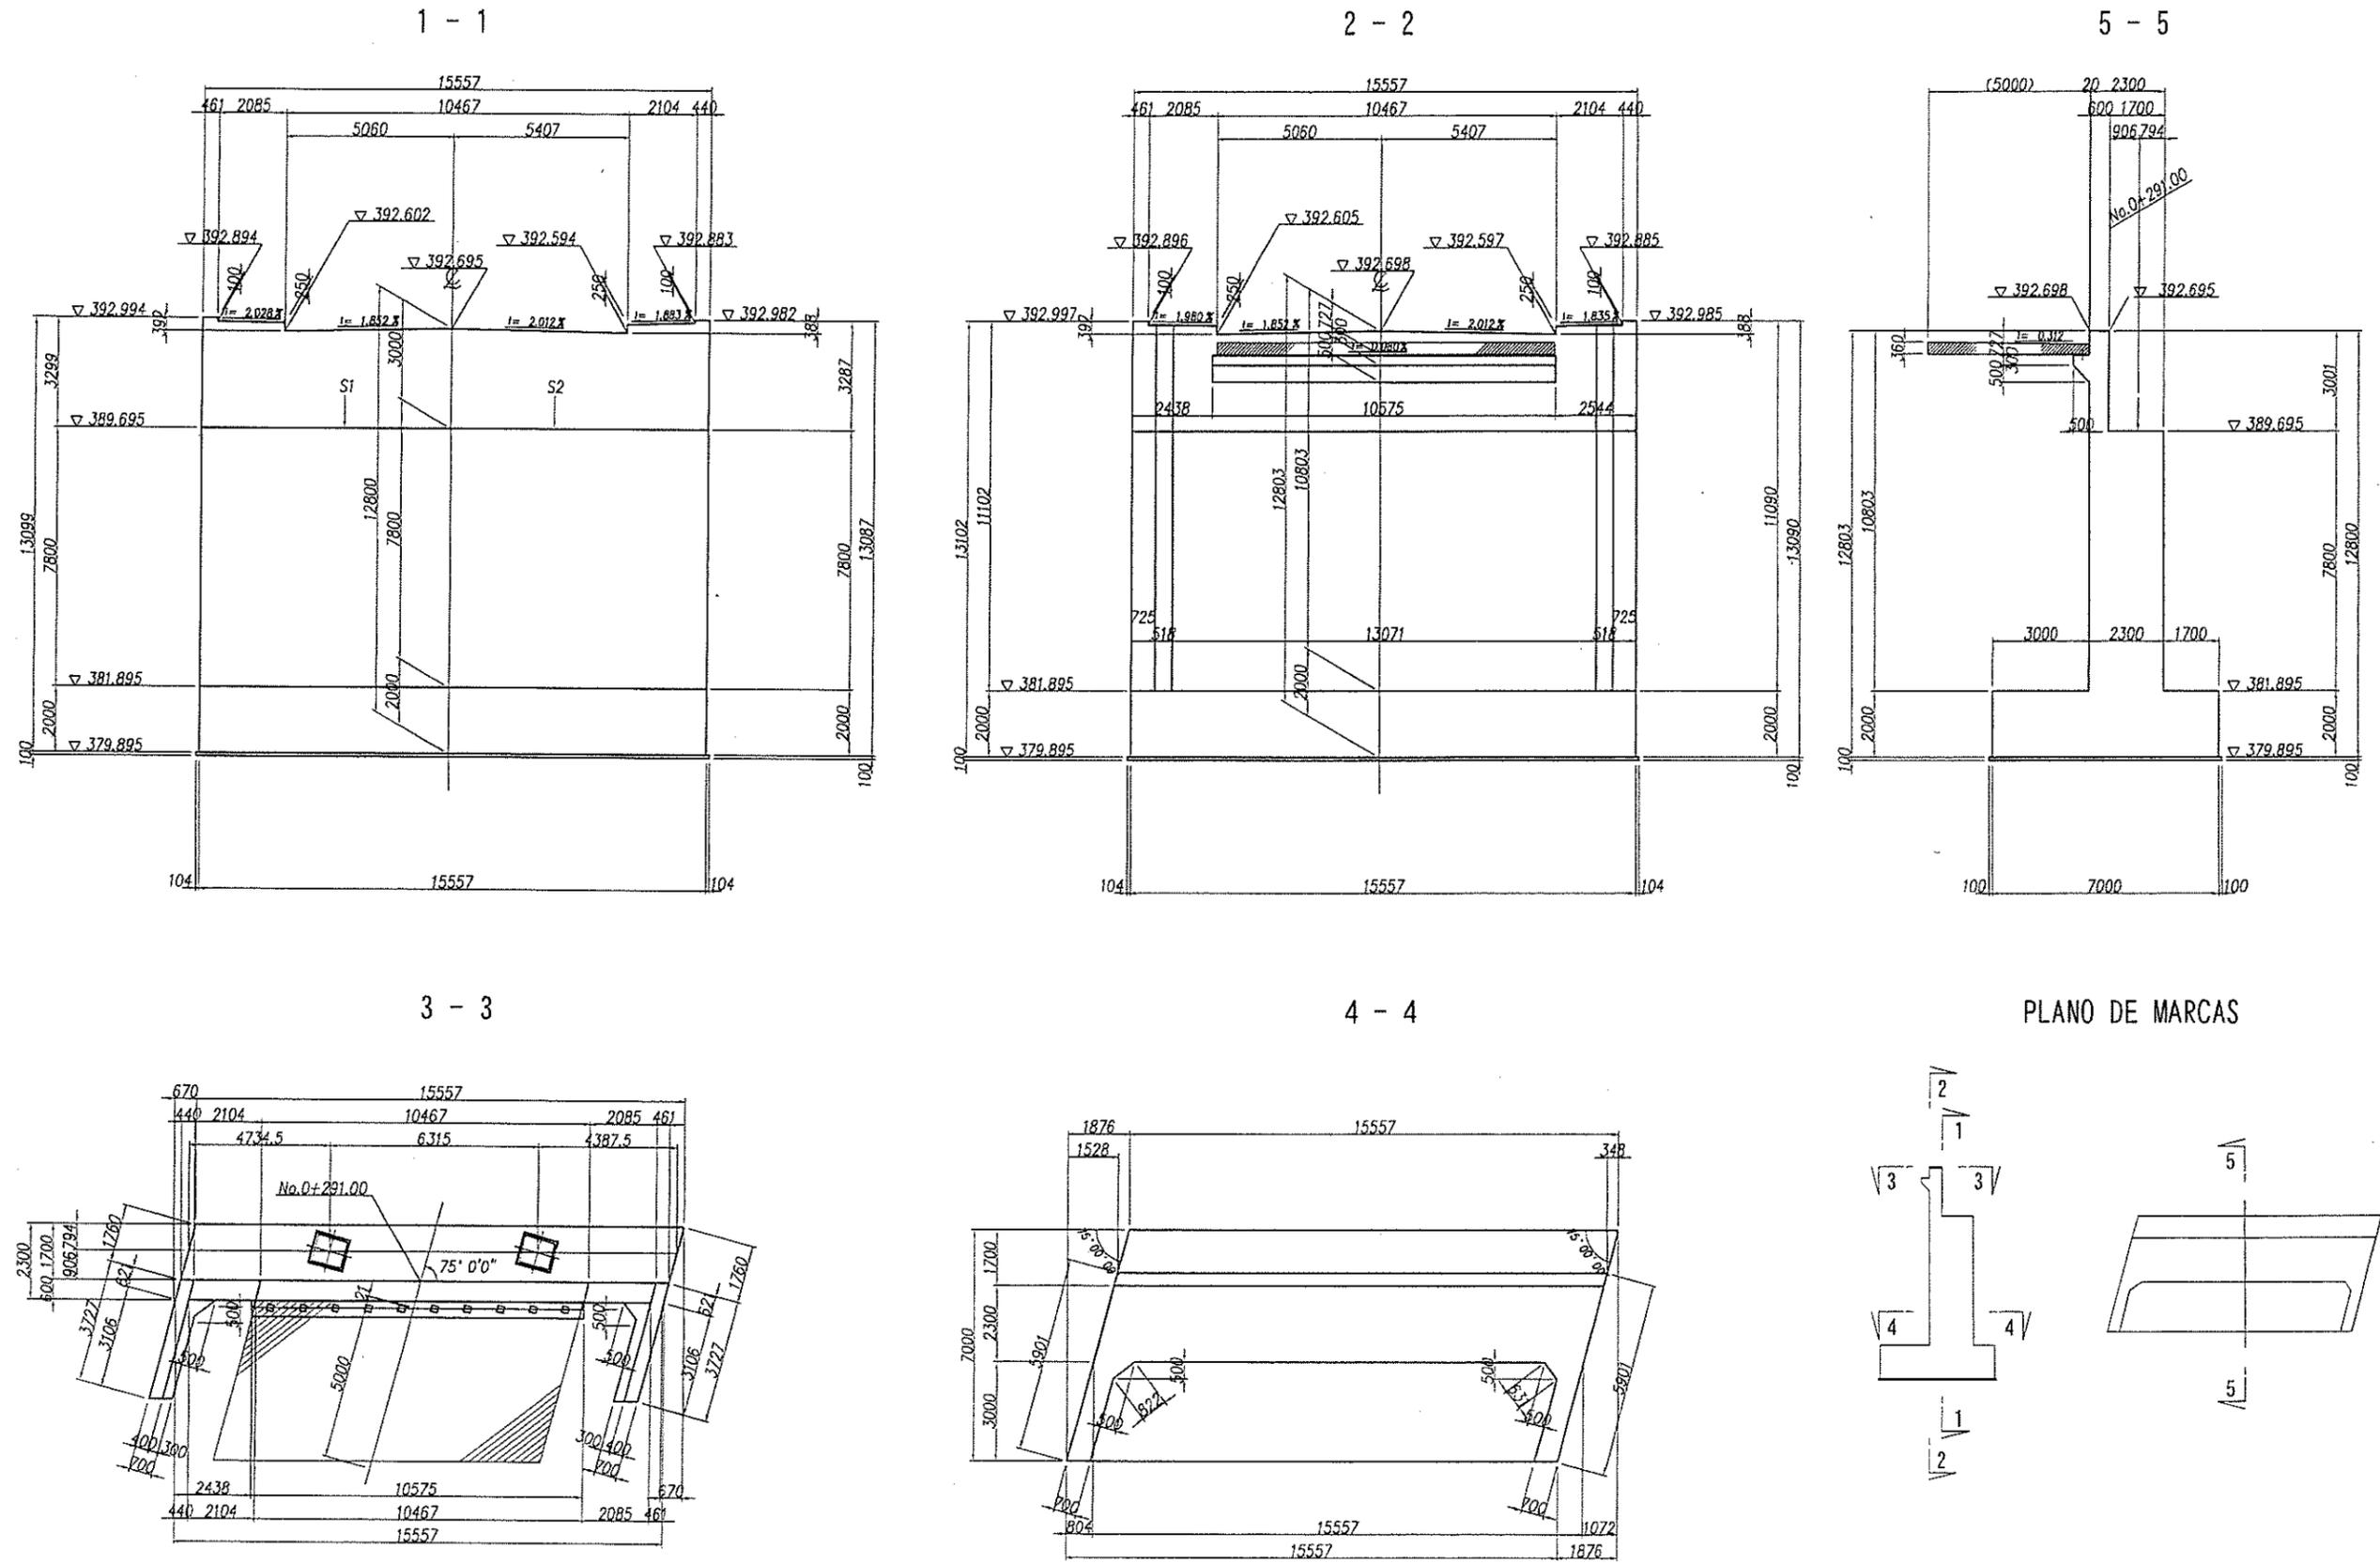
Plano Estructural de La Base del Puente A1 (1)
